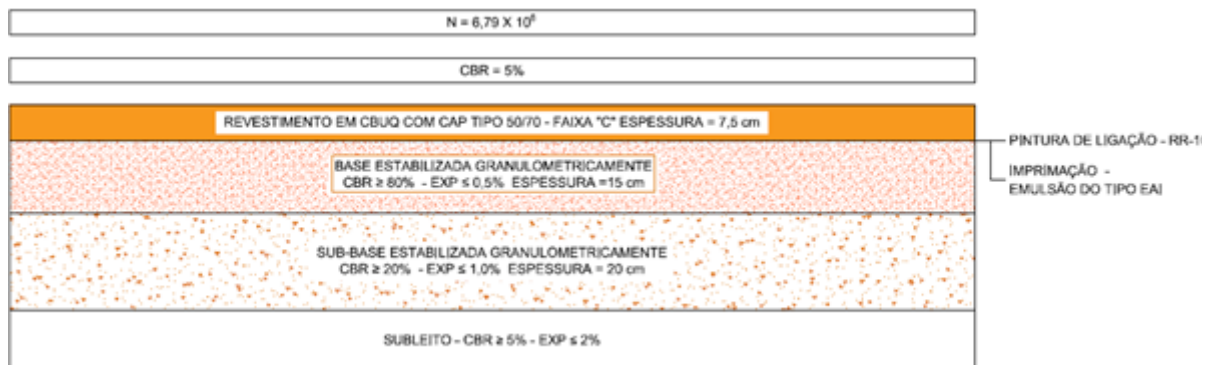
Detalhe da estrutura do pavimento dimensionado
